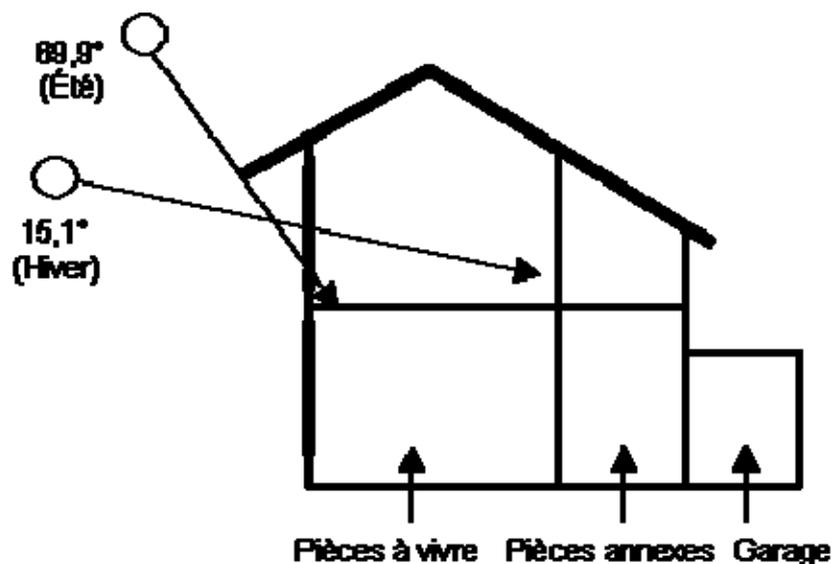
Exemple d'un bâtiment à planification favorable sur le plan énergétique [selon Pregizer, 2002]
